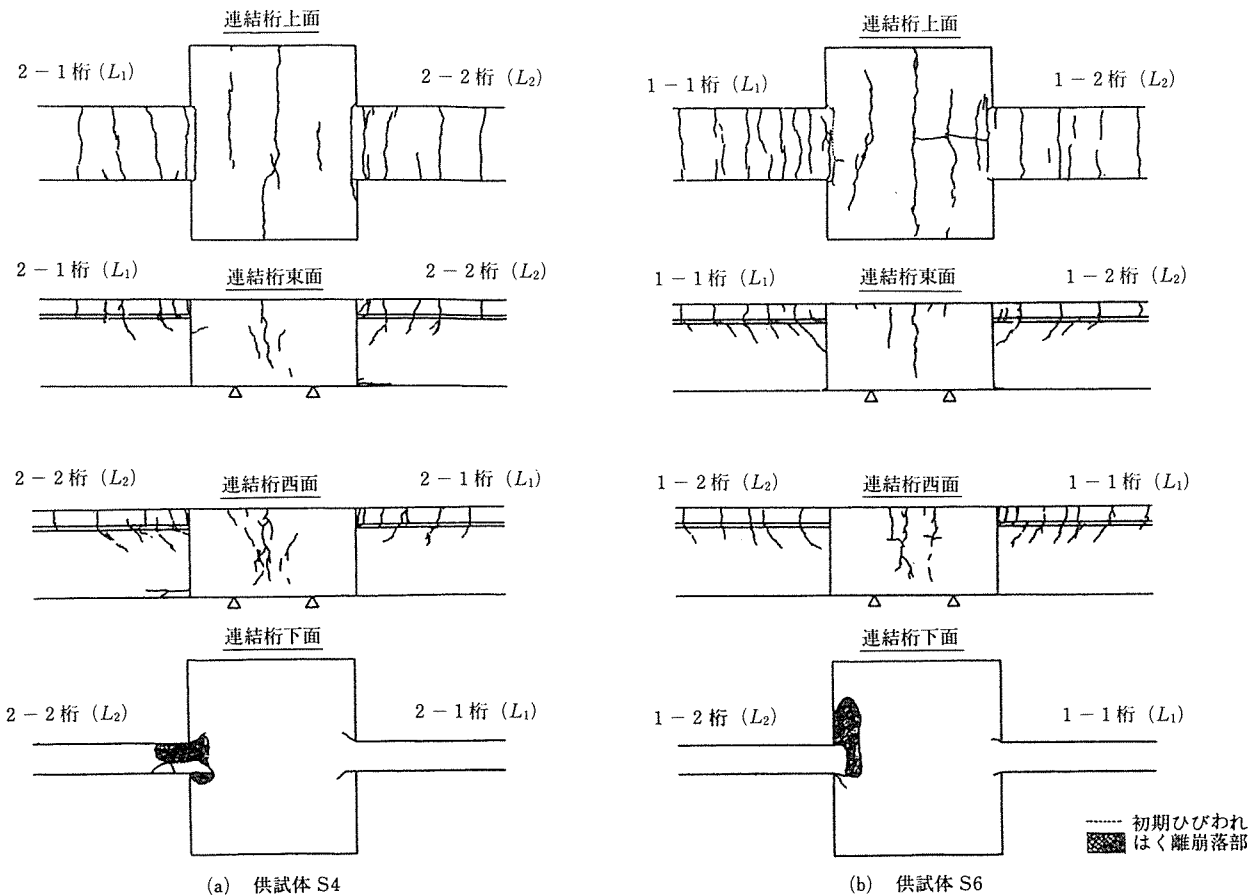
ひびわれ発生状況およびコンクリート圧壊状況
